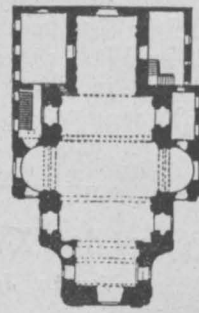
Grundriß der Leopoldskirche, II. Bez.
